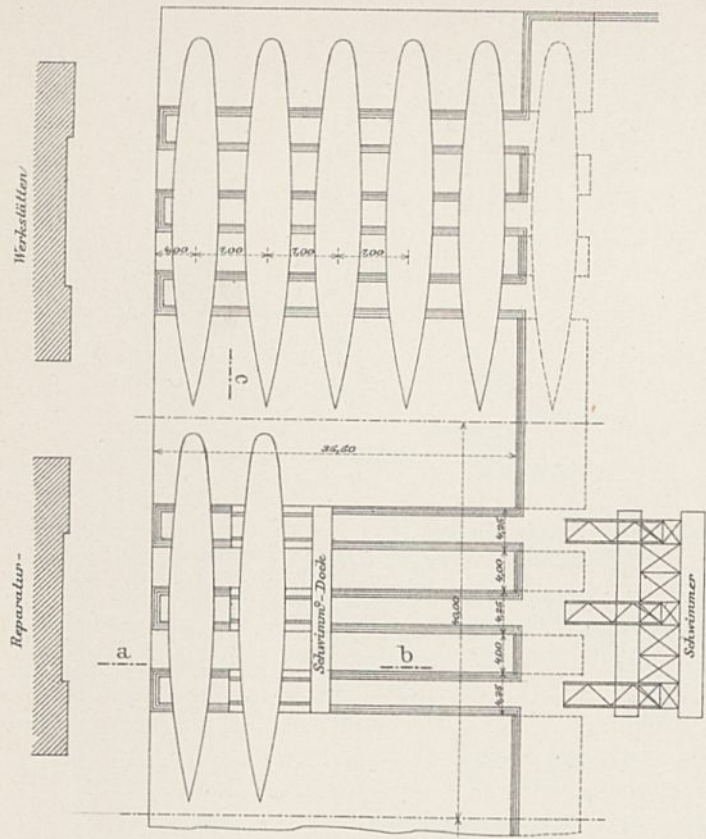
Belastetes Dock mit Schwimmer. Grundriss. 1:600.
